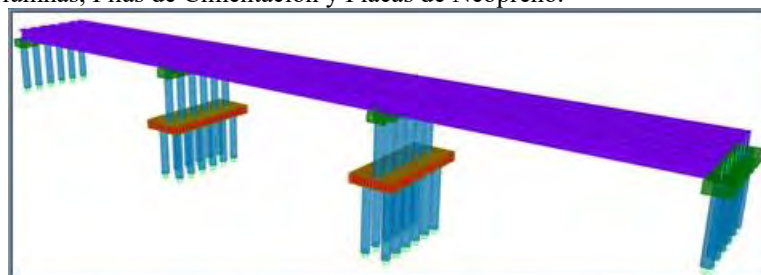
Modelo Tridimensional del Puente, Para Diseño de Cabezales y Pilas.
